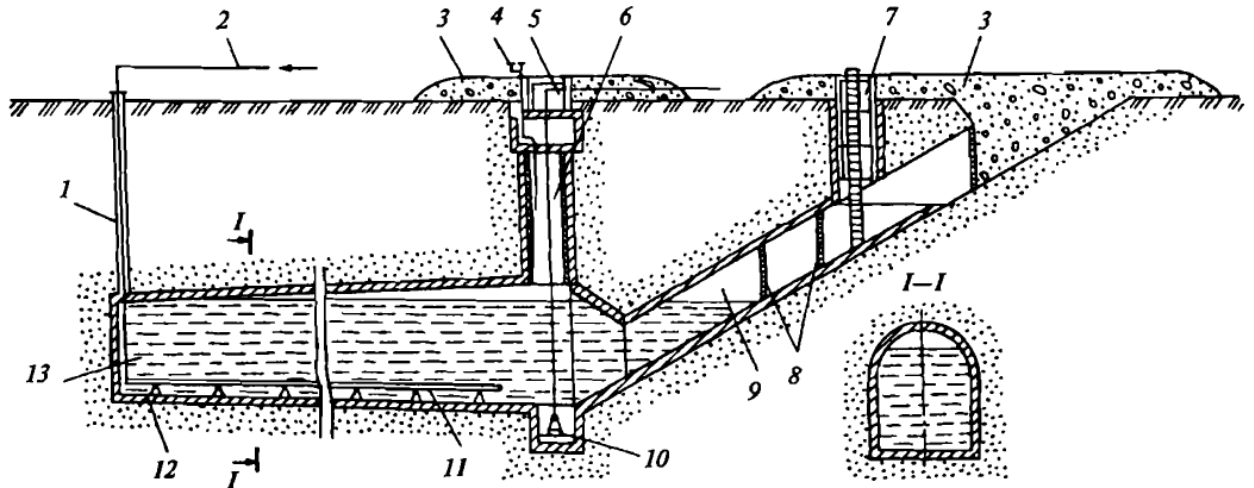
Принципиальная схема однокамерного шахтного резервуара
